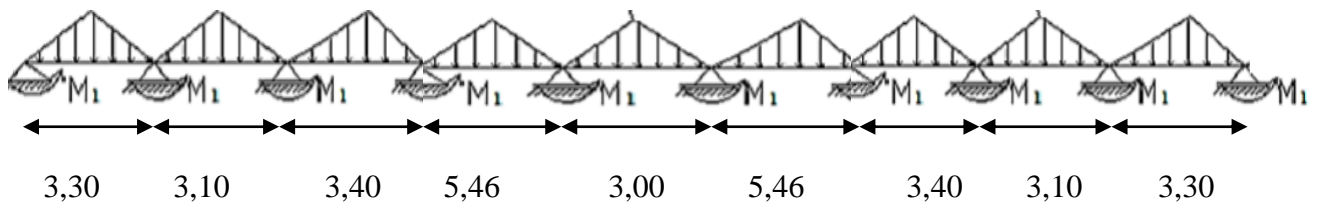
Distribution des charges sur les poutres secondaires.
